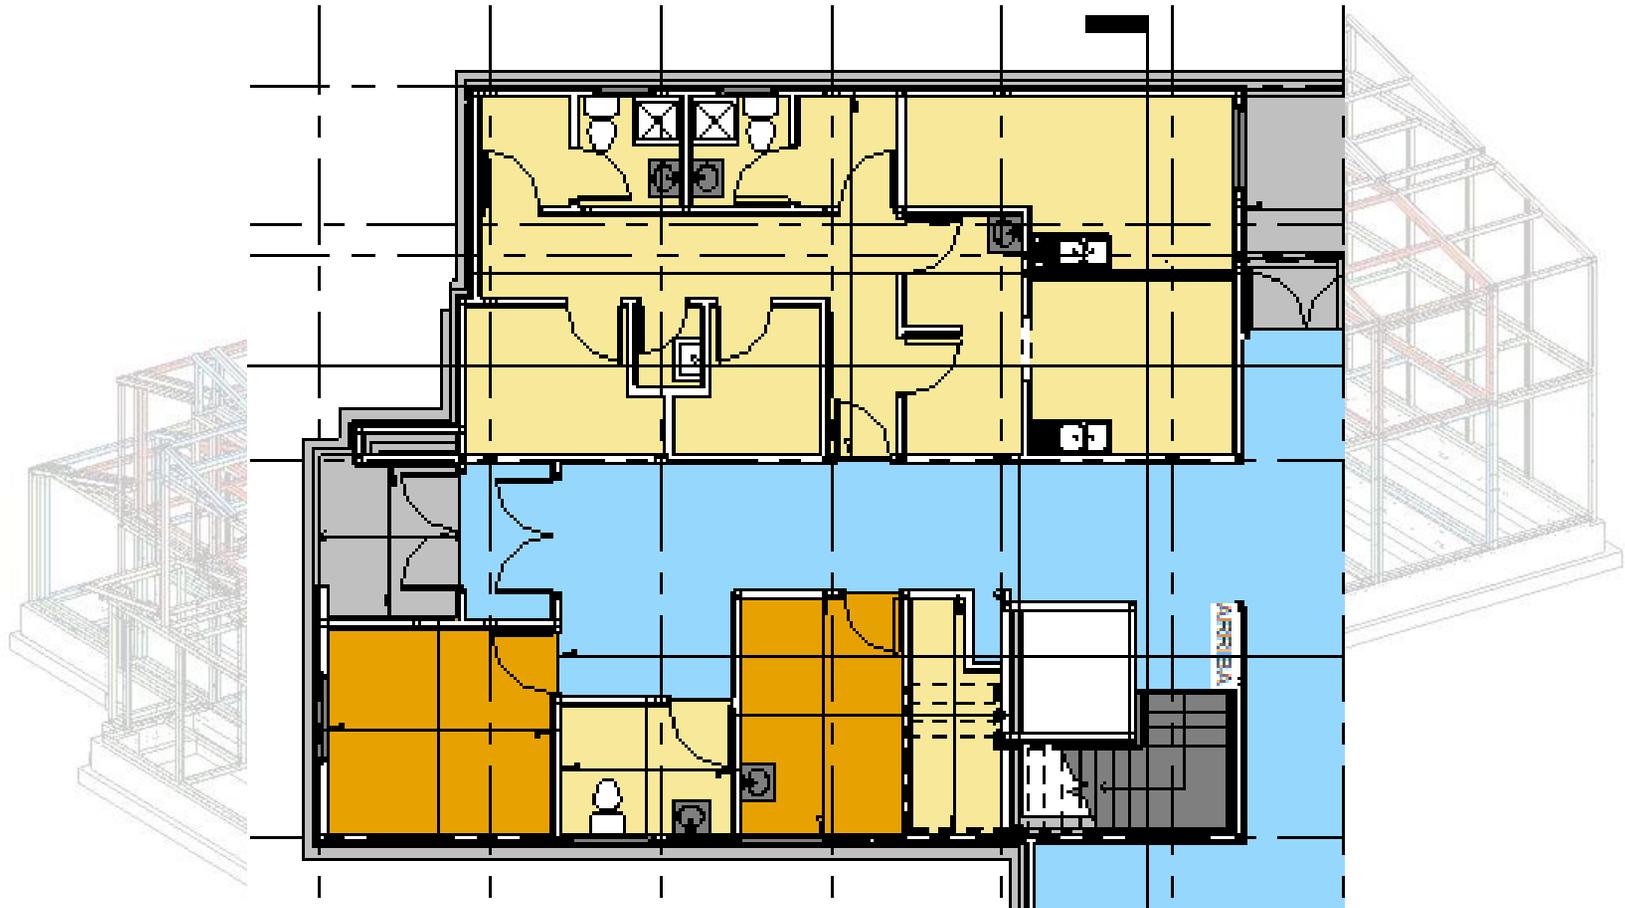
Planta modificada con 3 módulos con instalaciones y 2 bajantes. Elaboración propia.
